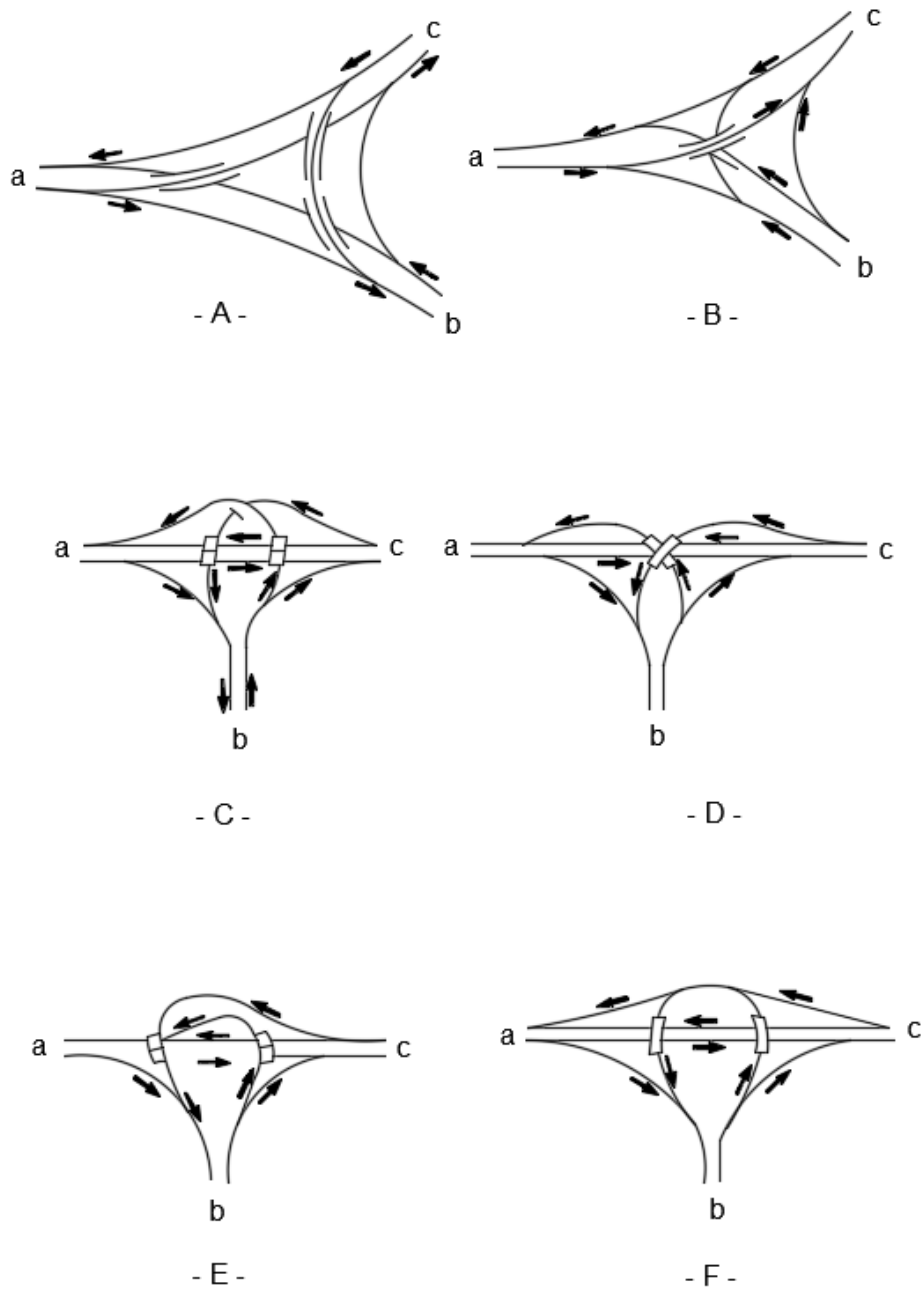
Intersecciones de tres ramas con estructuras múltiples
